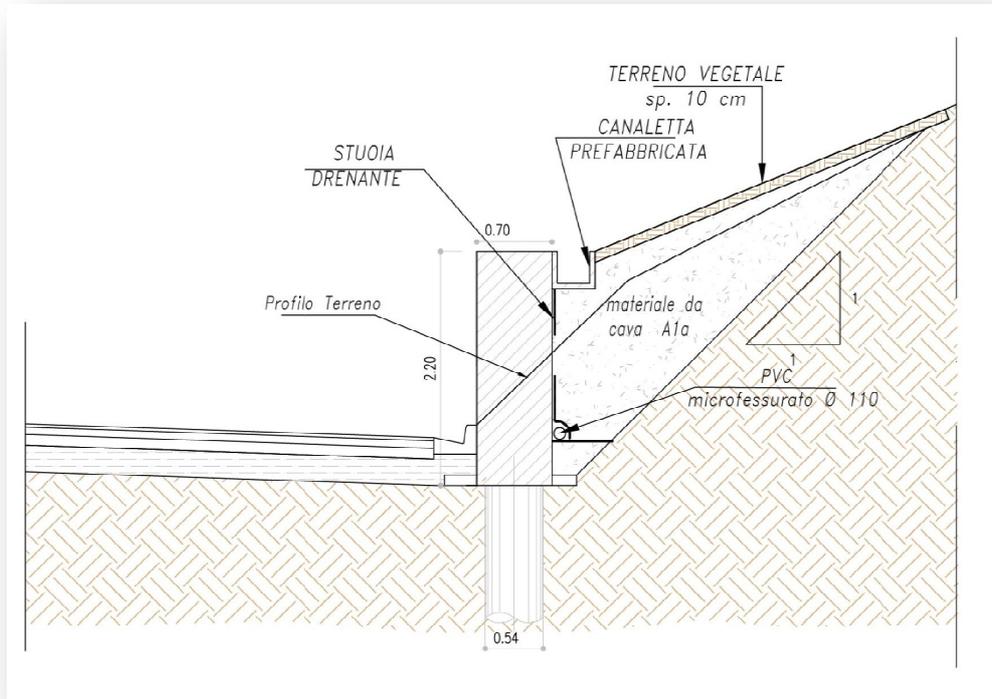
Muro di controripa tratto stradale da sez.57 a sez.66
